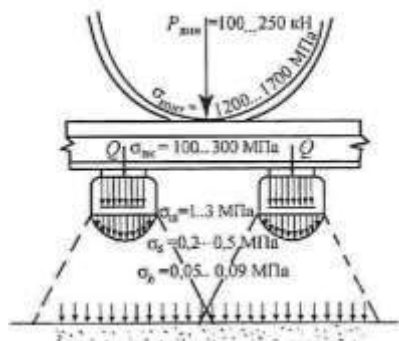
Схема передачи вертикальной нагрузки от колеса на ВСП
